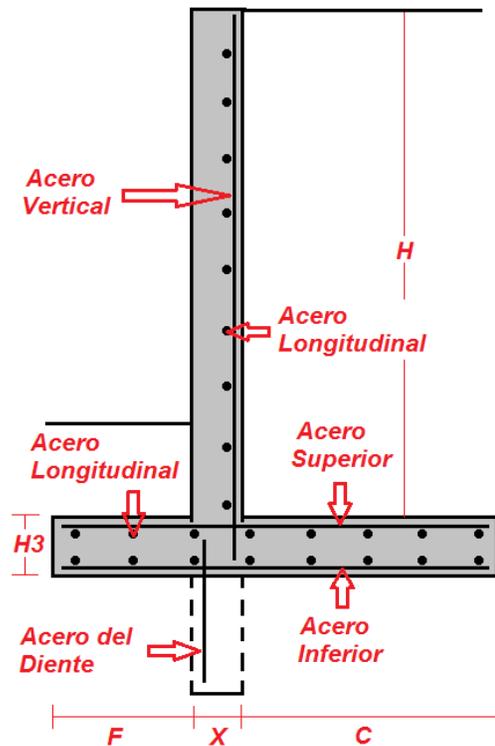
Colocación del acero para un muro de contención en concreto tipo voladizo
